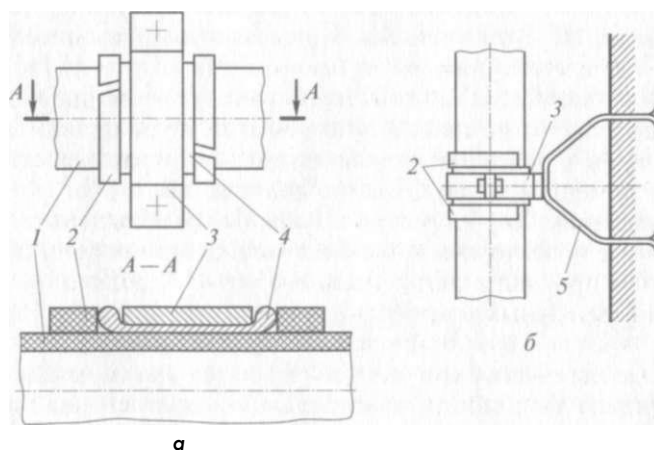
Неподвижные опоры горизонтальных (а) и вертикальных (б) трубопроводов из пластмасс:
